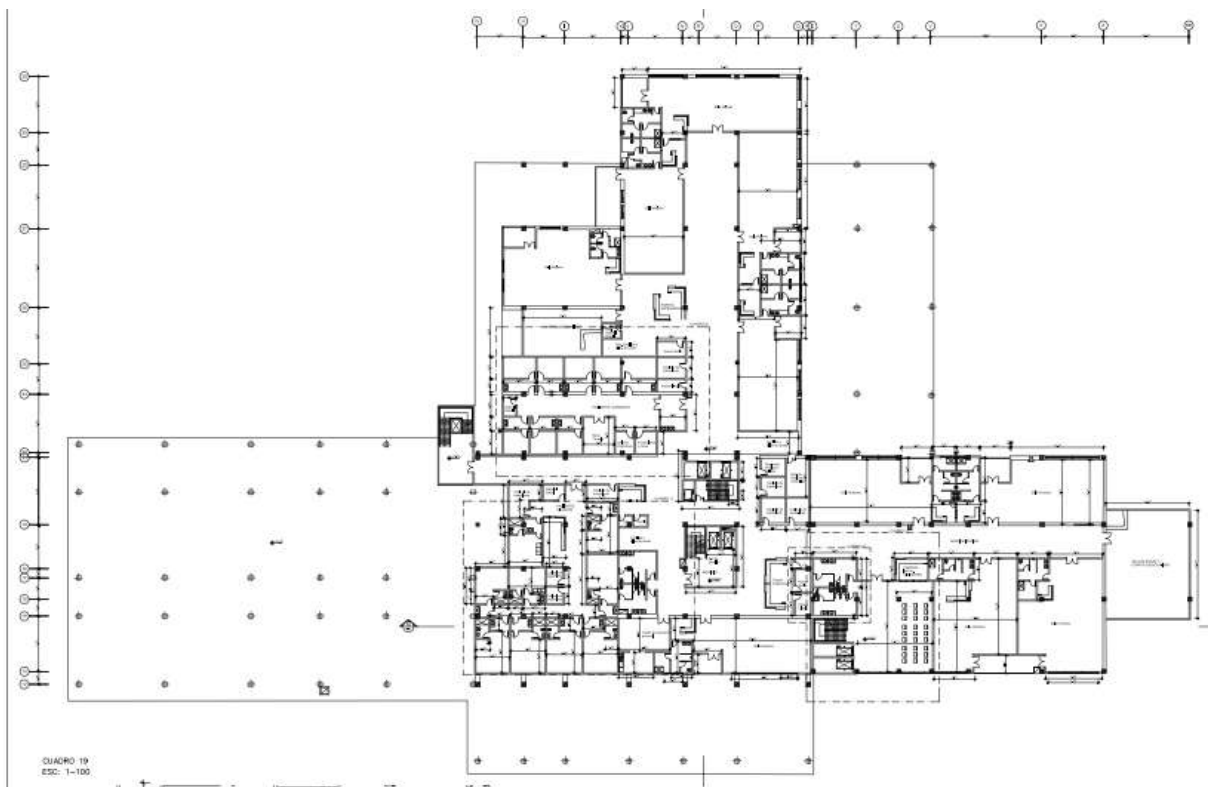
Planta Cuarto Piso Nivel ± 20.00 (2017)
